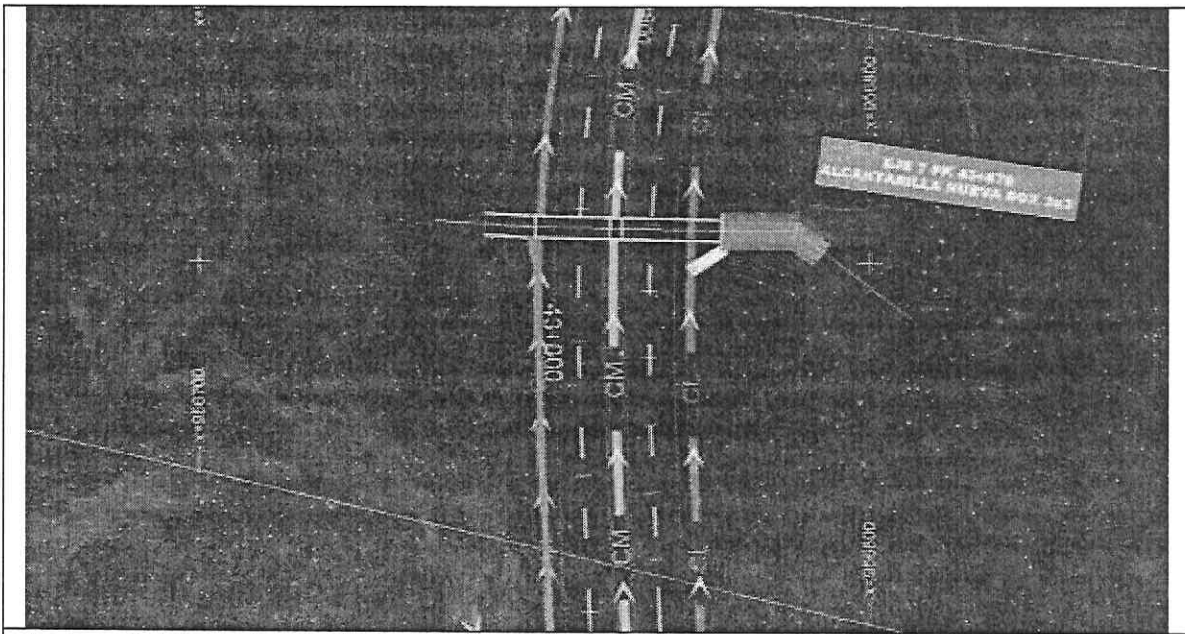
Ejecución pendiente del muro lateral izquierdo en encauzamiento de descole del box culvert PK43+870.
